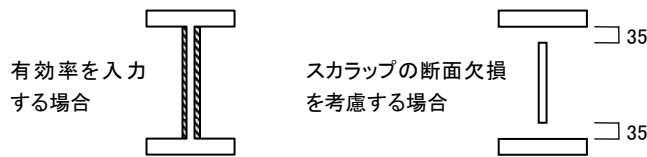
鉄骨大梁のウェブの有効断面
